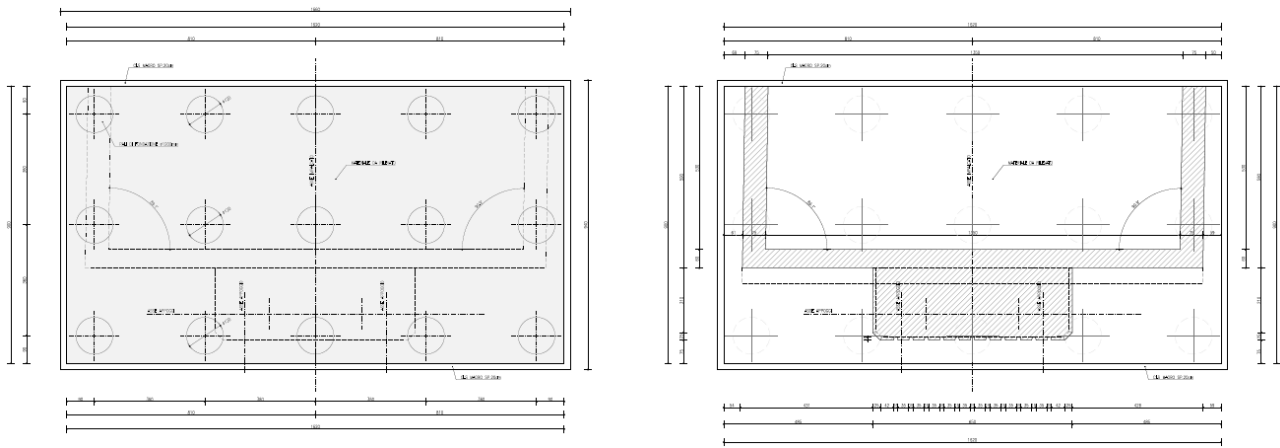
Spalla 2 – carpenteria fondazioni
